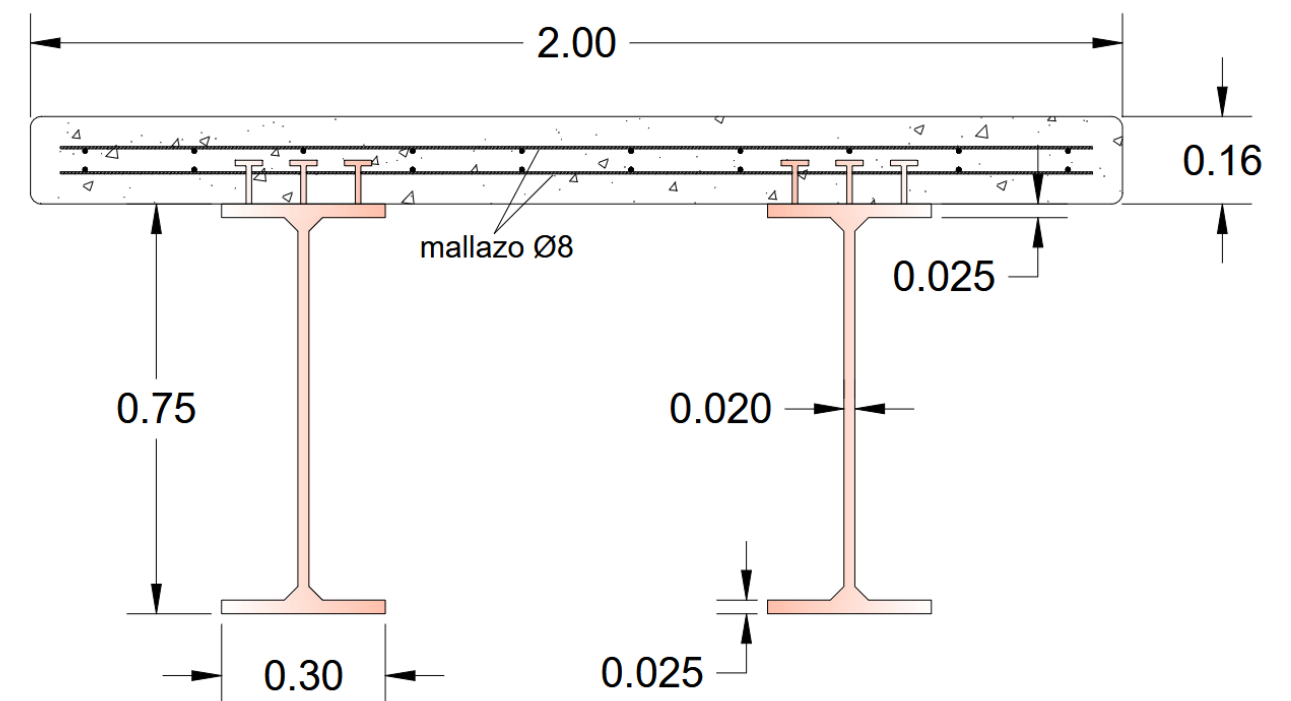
Predimensionamiento de la sección mixta. Fuente: Elaboración propia
